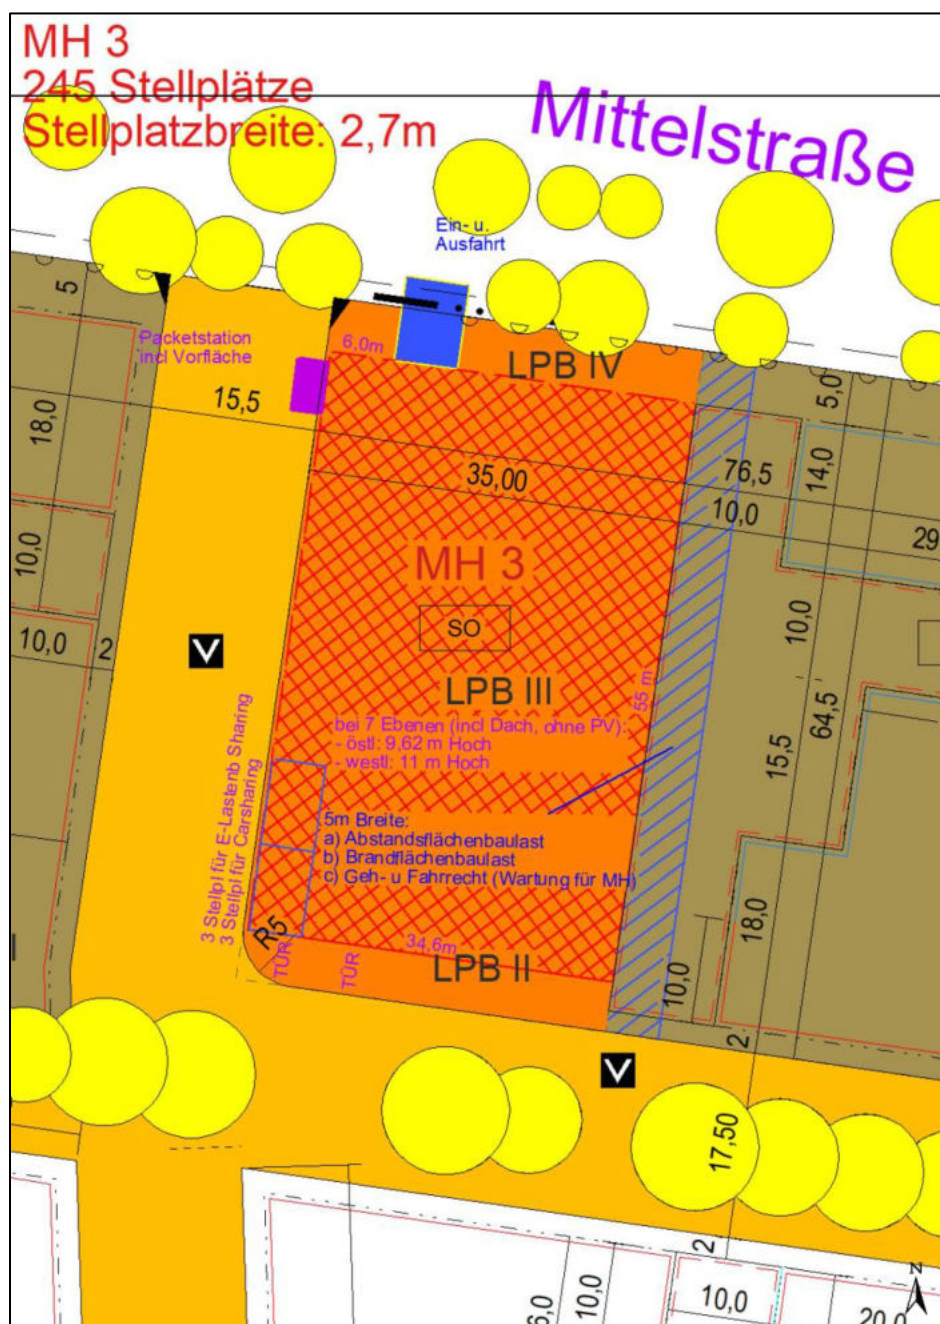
Lageplan zu MH 3 "Mittelstraße" /11/
